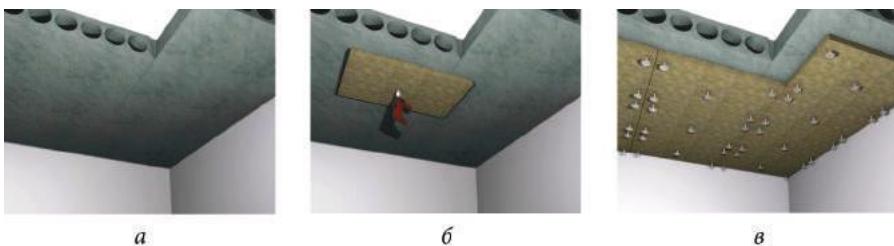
Последовательность монтажа огнезащиты железобетонных конструкций: *а* — подготовка поверхности железобетонной плиты перекрытия; *б* — подготовка отверстий для крепежа; *в* — установка крепежа
